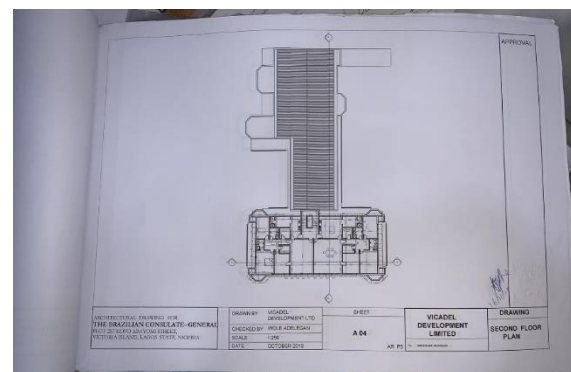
Planta baixa do segundo pavimento do projeto. Fonte: Cedido pelo Consulado-Geral em Lagos.
